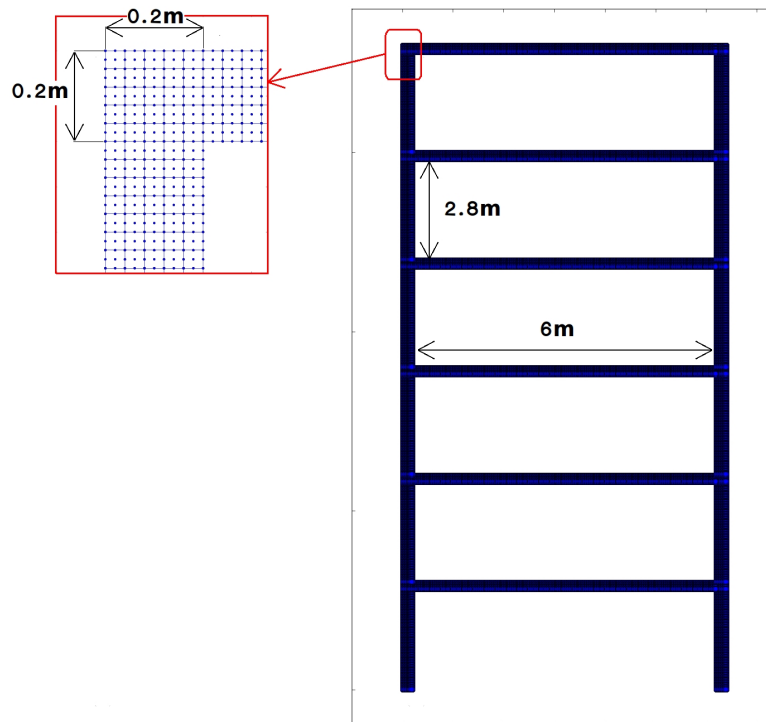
Schéma d'un bâtiment de six étages, en haut à gauche : détails du maillage.
